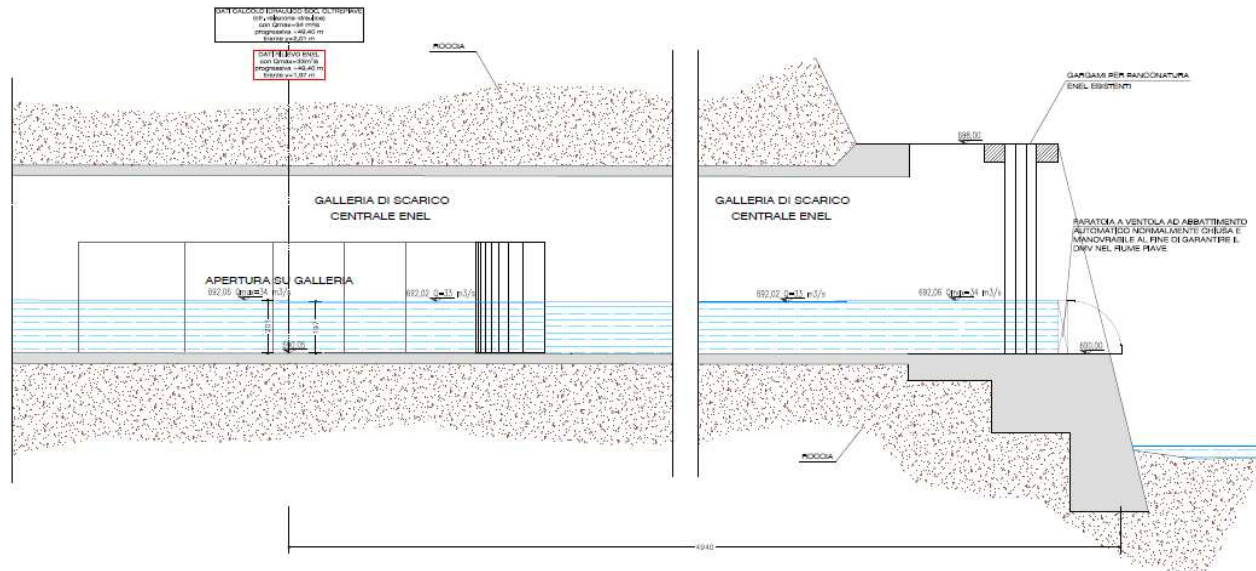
Estratto Tav. 7 -Particolare sezione terminale canale di scarico esistente con nuovi interventi.
